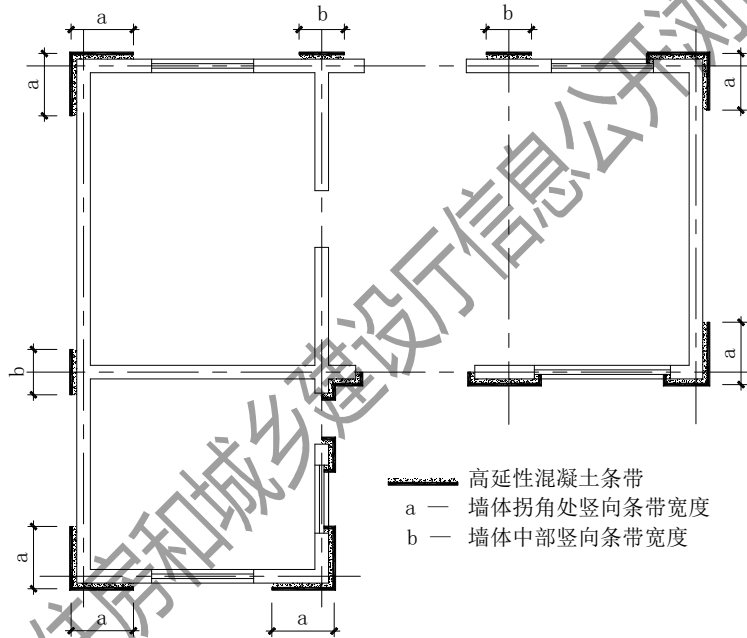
高延性混凝土竖向条带设置平面示意图
